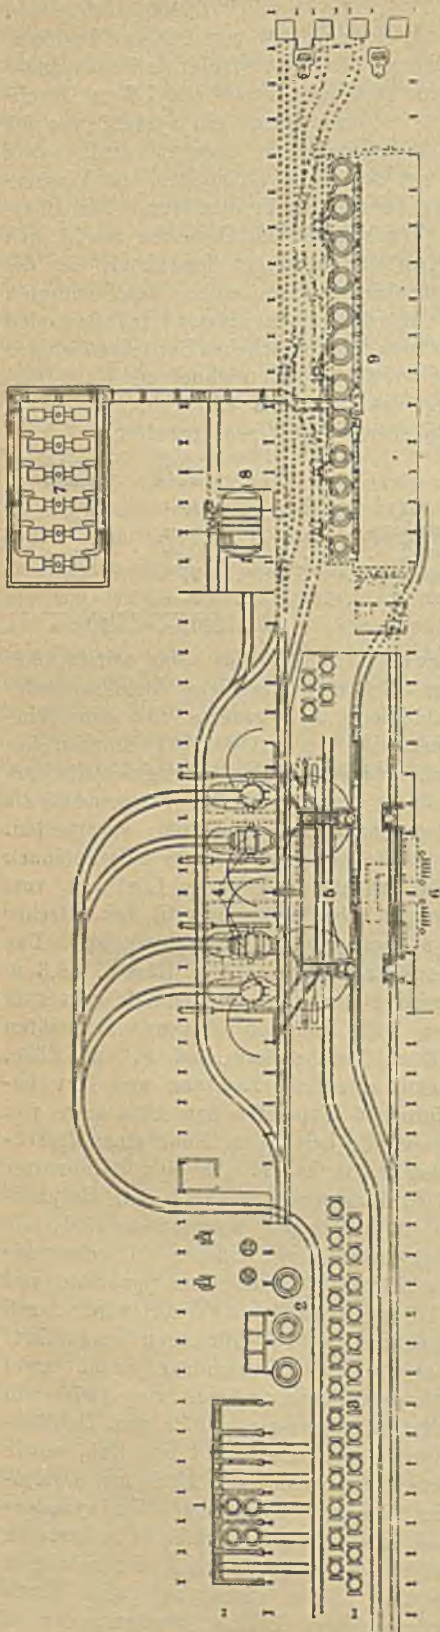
Lageplan des Bessemerstahlwerks der Lackawanna Steel Co.
